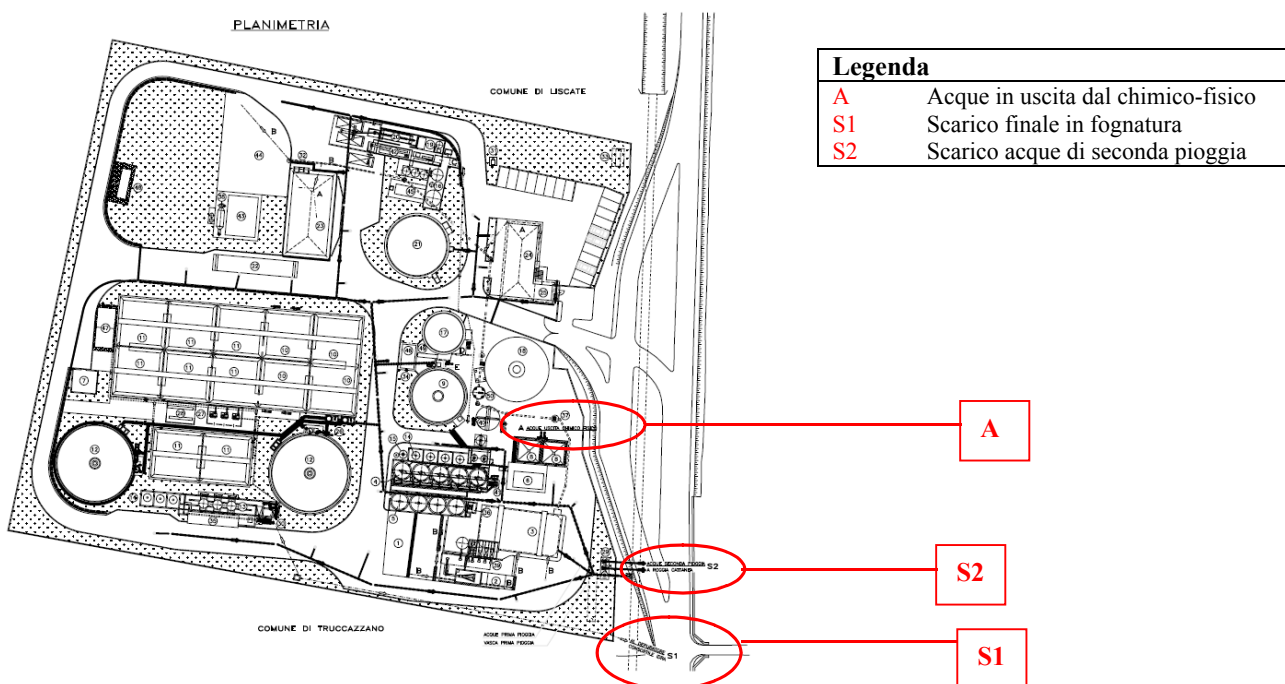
Planimetria dell'impianto con evidenza dei punti A, S1 e S2
